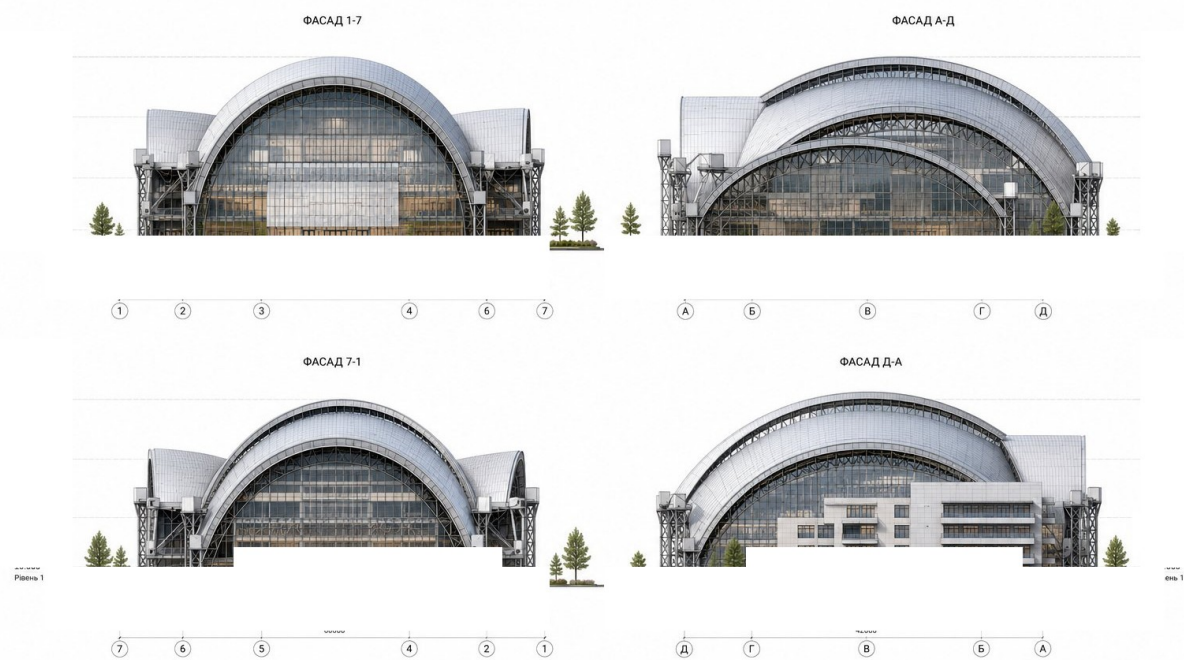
Фасади будівлі (ортогональні проєкції).
